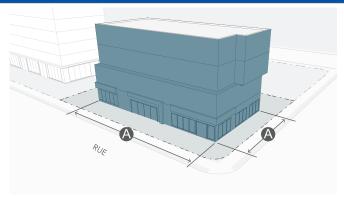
Mesure de la largeur d'une façade lorsqu'au moins un établissement d'un bâtiment est uniquement accessible par un couloir, un corridor ou un escalier intérieur
